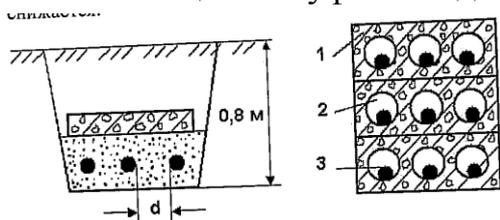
Эскиз прокладки кабелей в земляной траншее и бетонном блоке.
